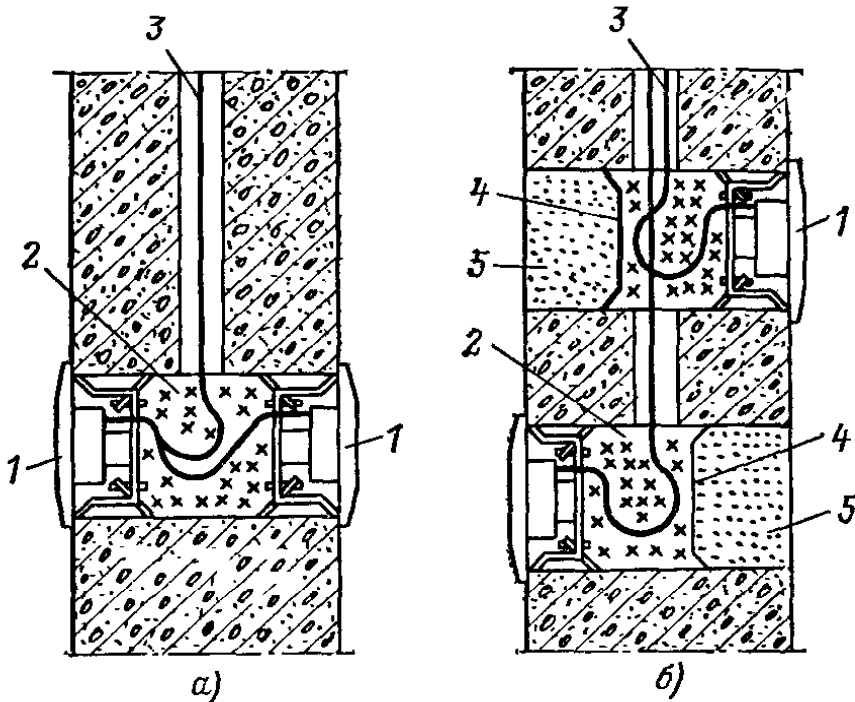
Узлы установки штепсельных розеток в стеновых панелях для межкомнатной (а) и межквартирной перегородки (б):
